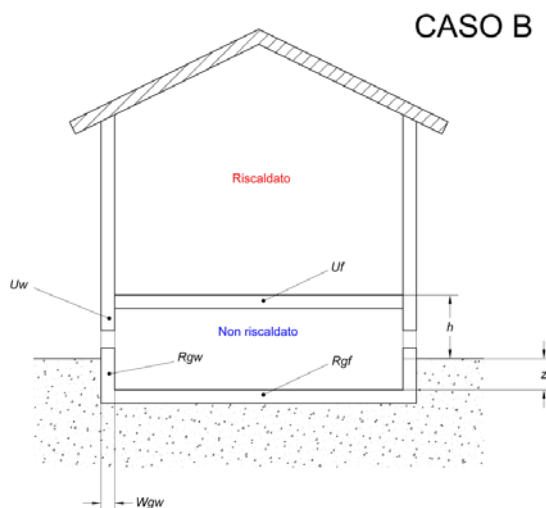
Basamento CASO B - Pavimento su spazio aereo
